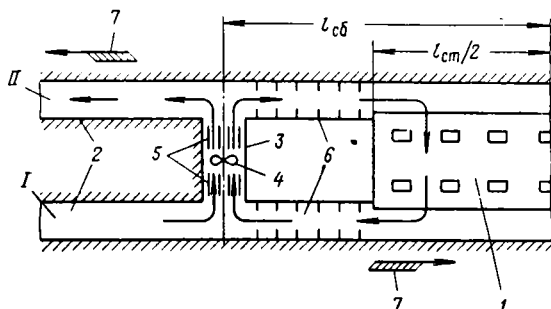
VII. Схема системы вентиляции тоннелей с устройством циркуляционной сбойки и расположением вентилятора у торца станции:
